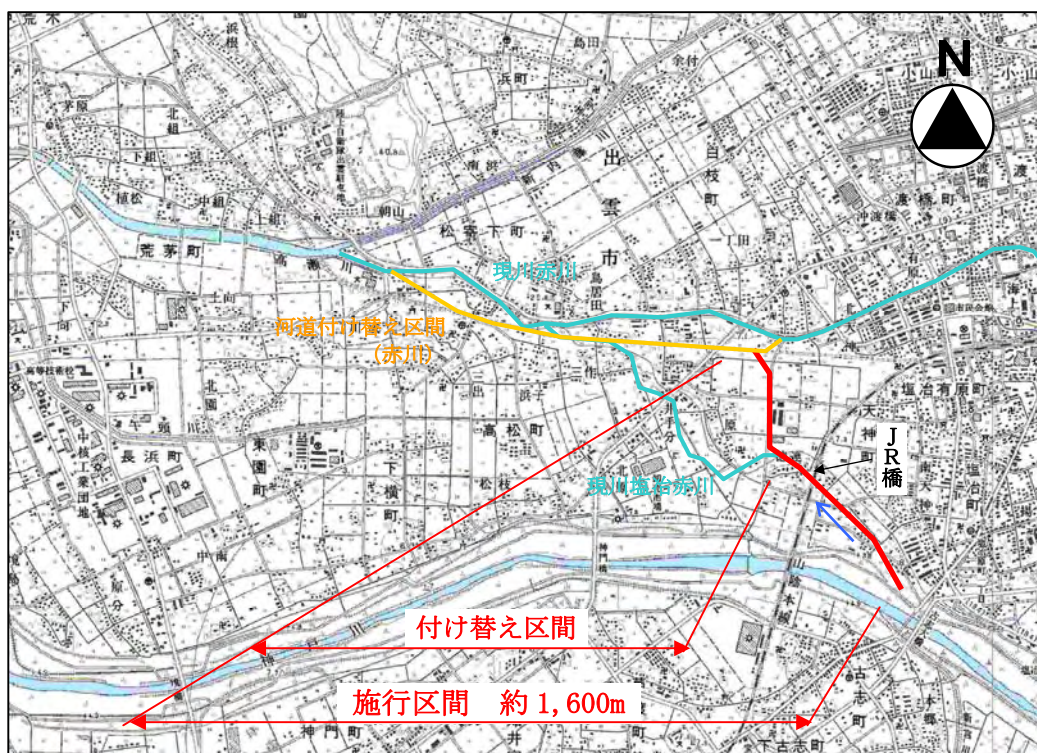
塩冶赤川平面図 (S=1:40,000)
